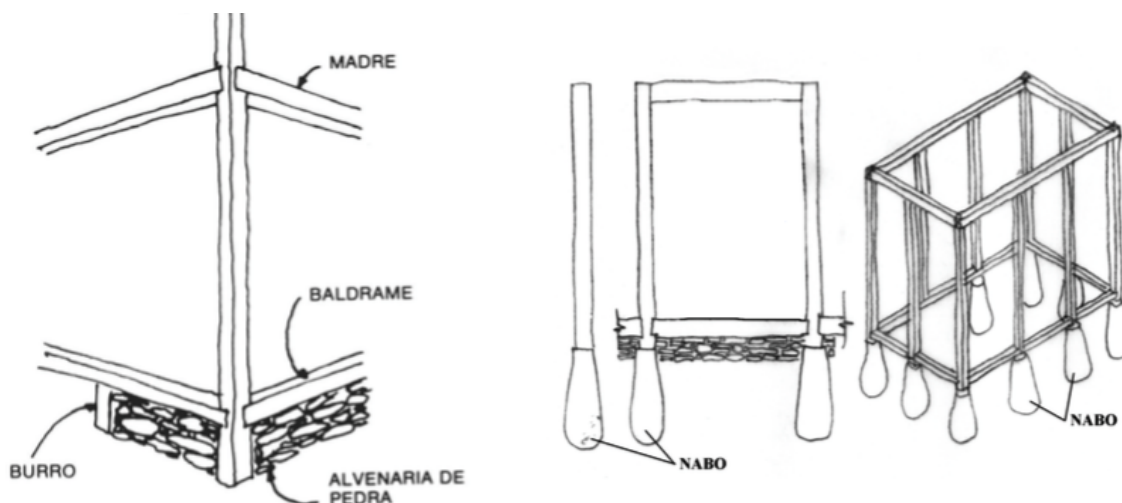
| Detalhe construtivo da estrutura autónoma brasileira.
